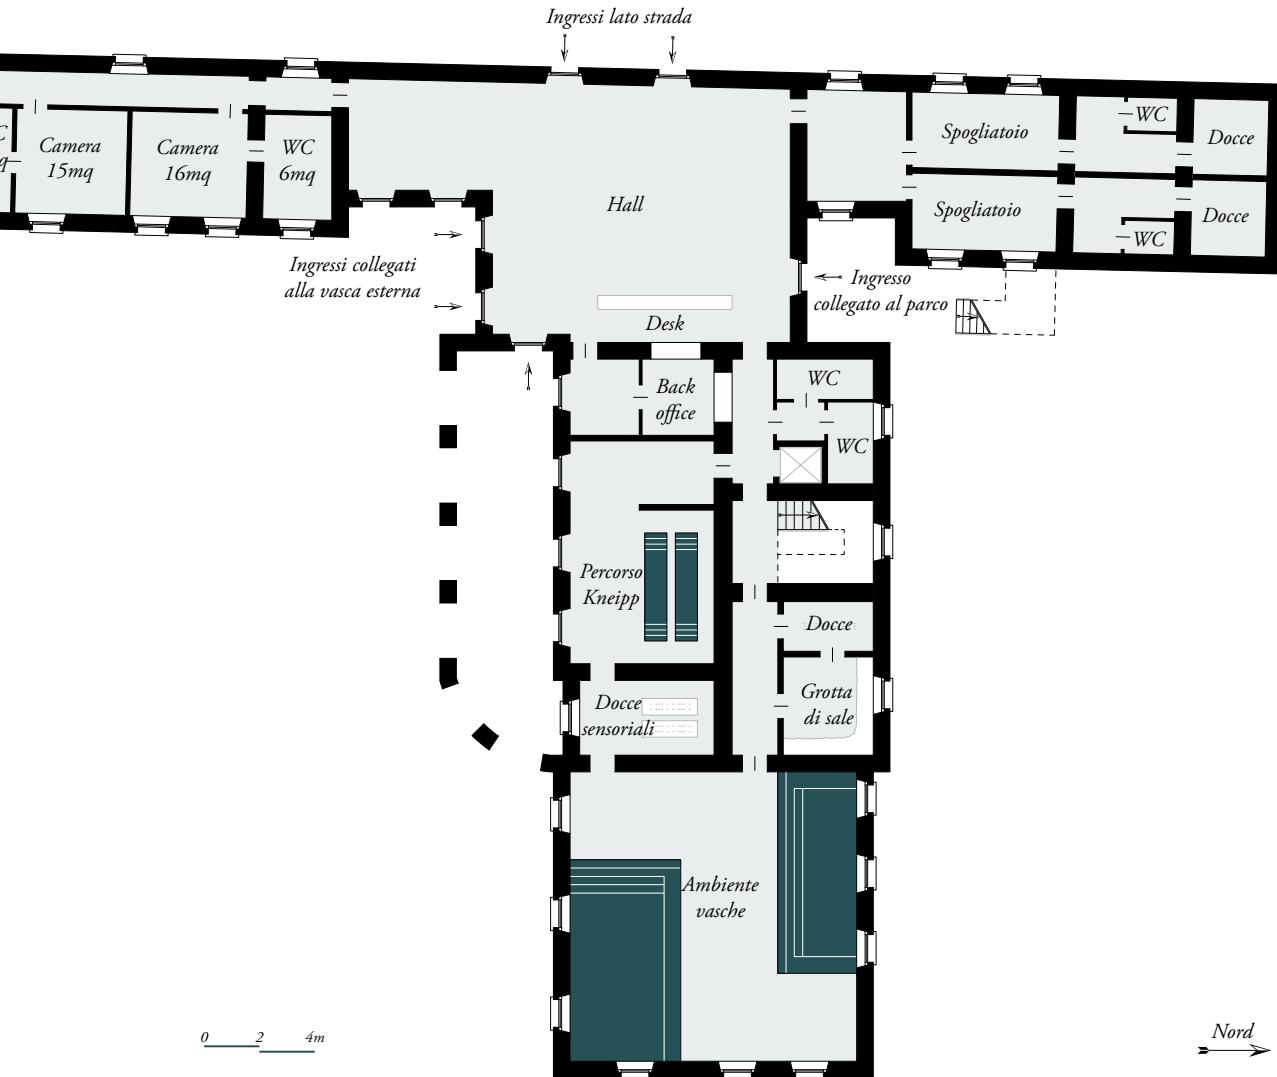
Hotel Paradiso, planimetria di progetto piano terreno (fuori scala).
